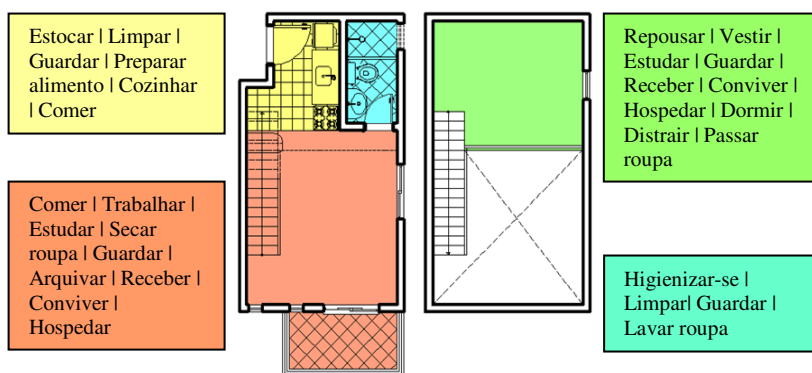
Planta esquemática indicando a funcionalidade dos espaços: a) Primeiro pavimento e b) Mezanino.
